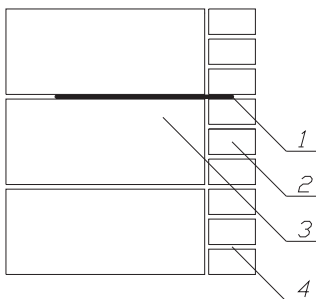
Узел перевязки внешней стены с внутренними стенами
